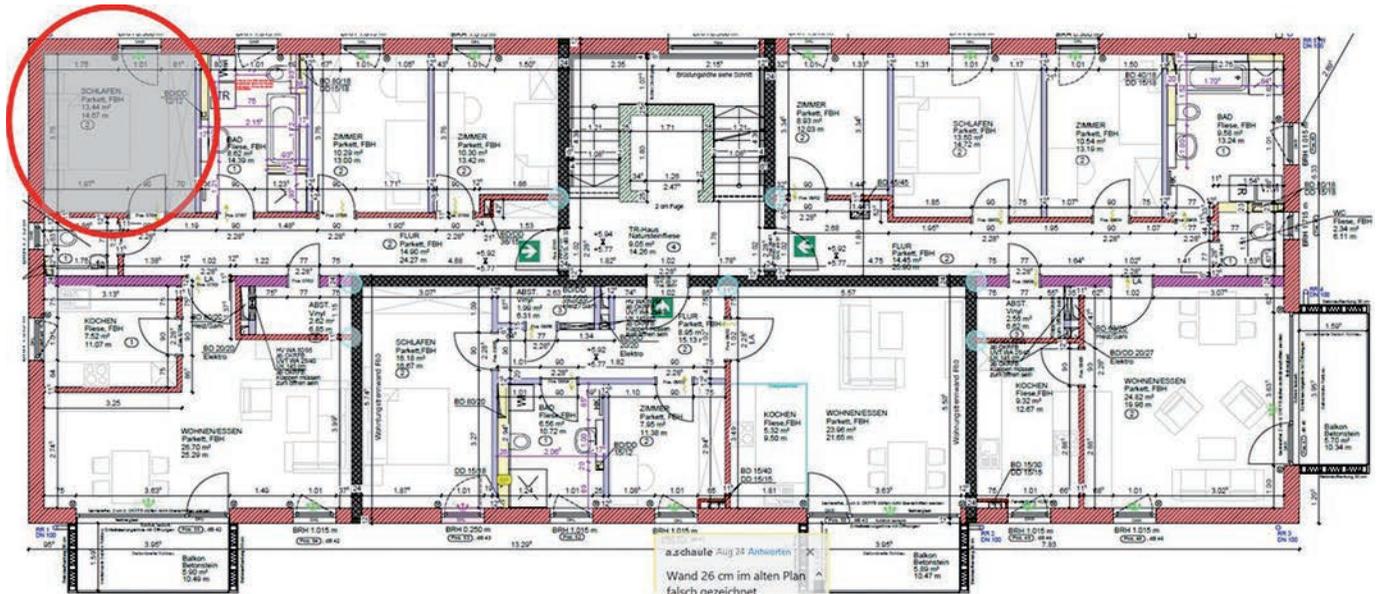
Grundriss eines Mehrfamiliengebäudes
